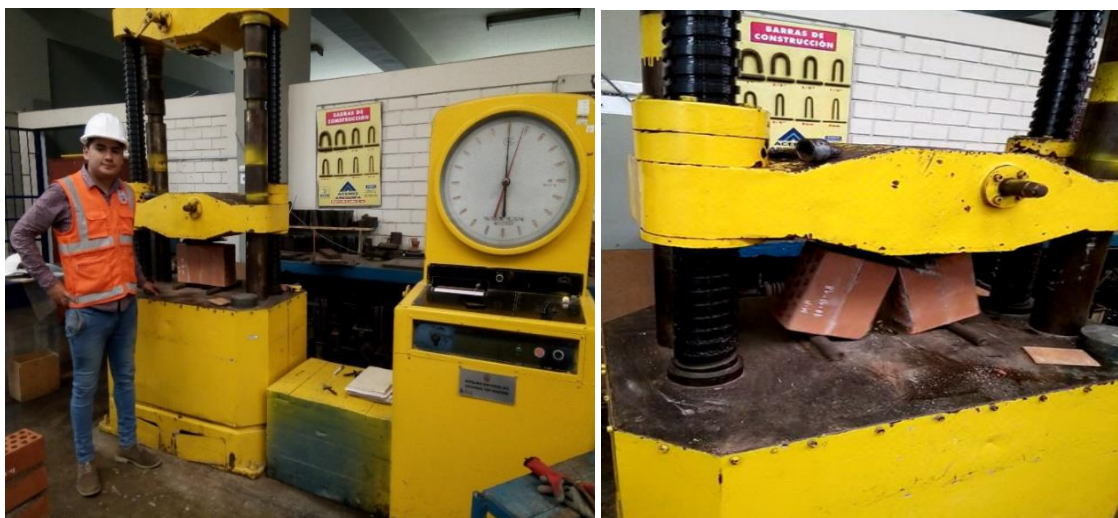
Ensayos de tracción por flexión en pilas con mortero polimérico - fotos
